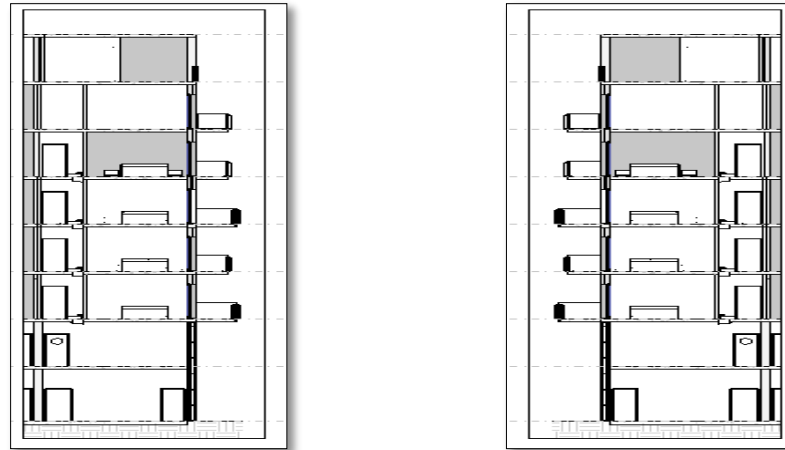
Photo : à droite, coupe 1 ; à gauche, coupe 2, Source : auteur
